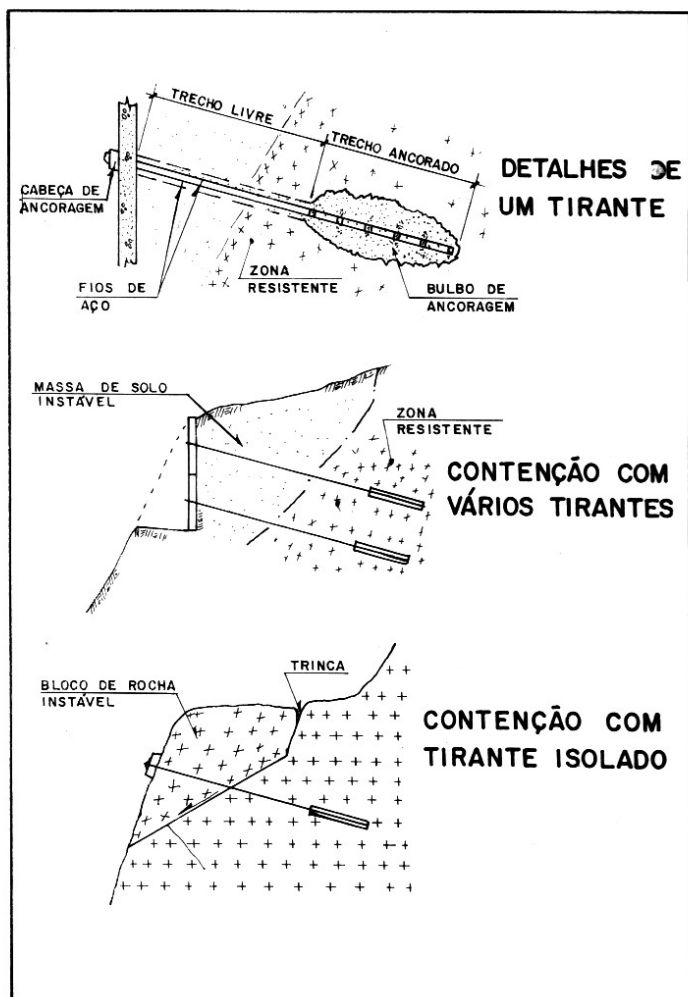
Detalhes de um tirante e exemplos de aplicação
